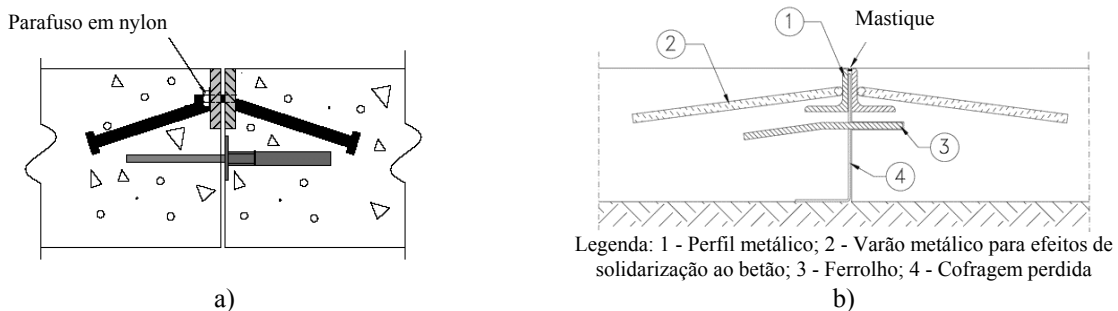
Soluções de protecção de juntas de construção: a) sistema proposto por “Permaban”; b) sistema proposto por “Peikko”
